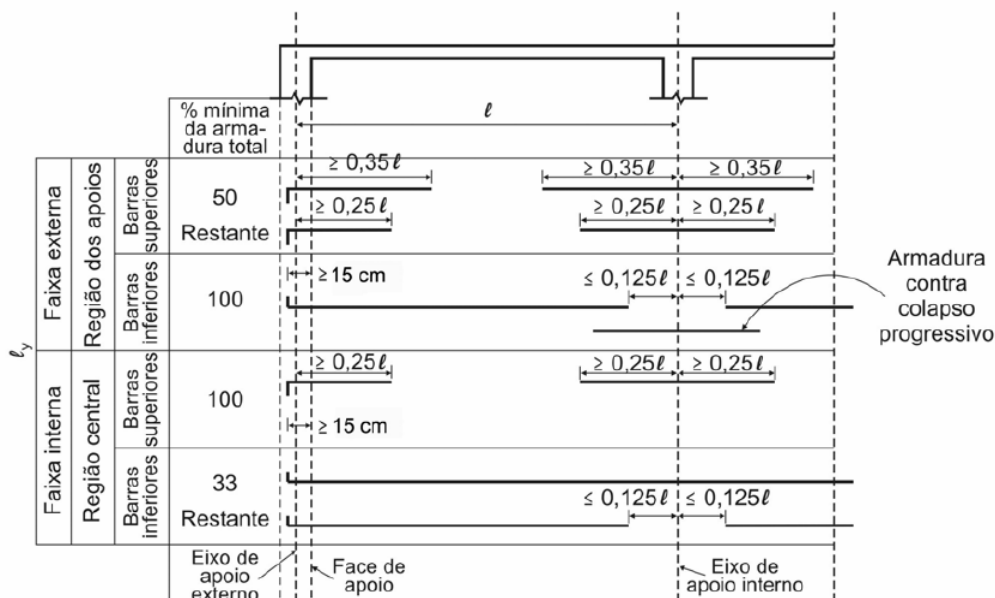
disposições para armaduras passivas em lajes sem vigas (ASSOCIAÇÃO BRASILEIRA DE NORMAS TÉCNICAS, 2007)
